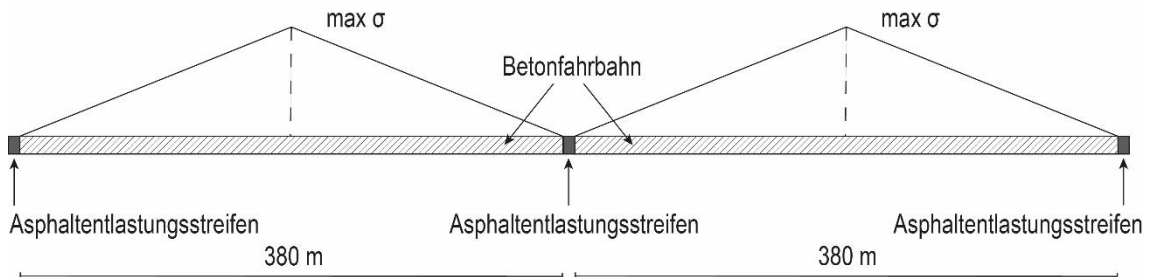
Festlegung der Abstände der Entlastungsschnitte mit Asphaltersatz in alten Betonfahrbahndecken (Liegedauer > 30 Jahre) aus dem Jahr 2013
